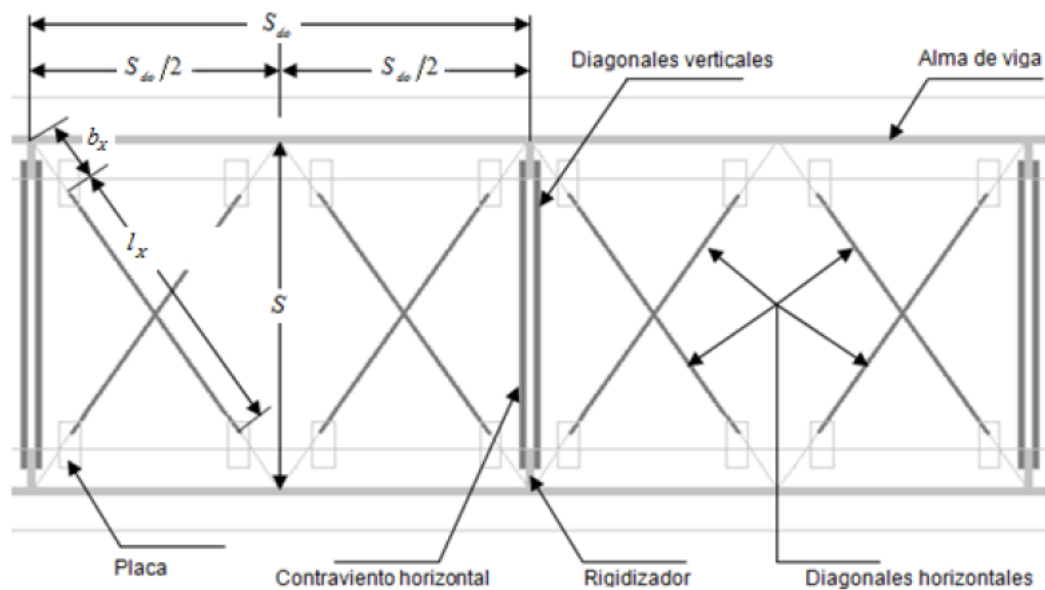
Contraviento horizontal (diagonales inferiores). Fuente: (Rúales Fonseca, 2014, p. 205)
